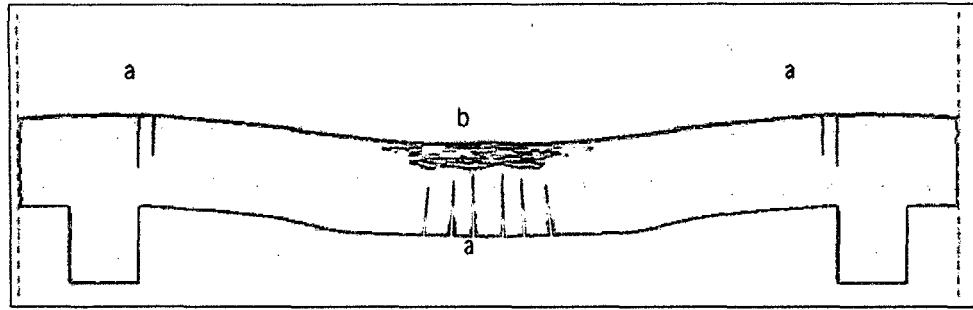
1. Fisuras transversales en vigas debido a esfuerzos de tracción. Fuente: (Stuardo P., 2008, pág. 171)
